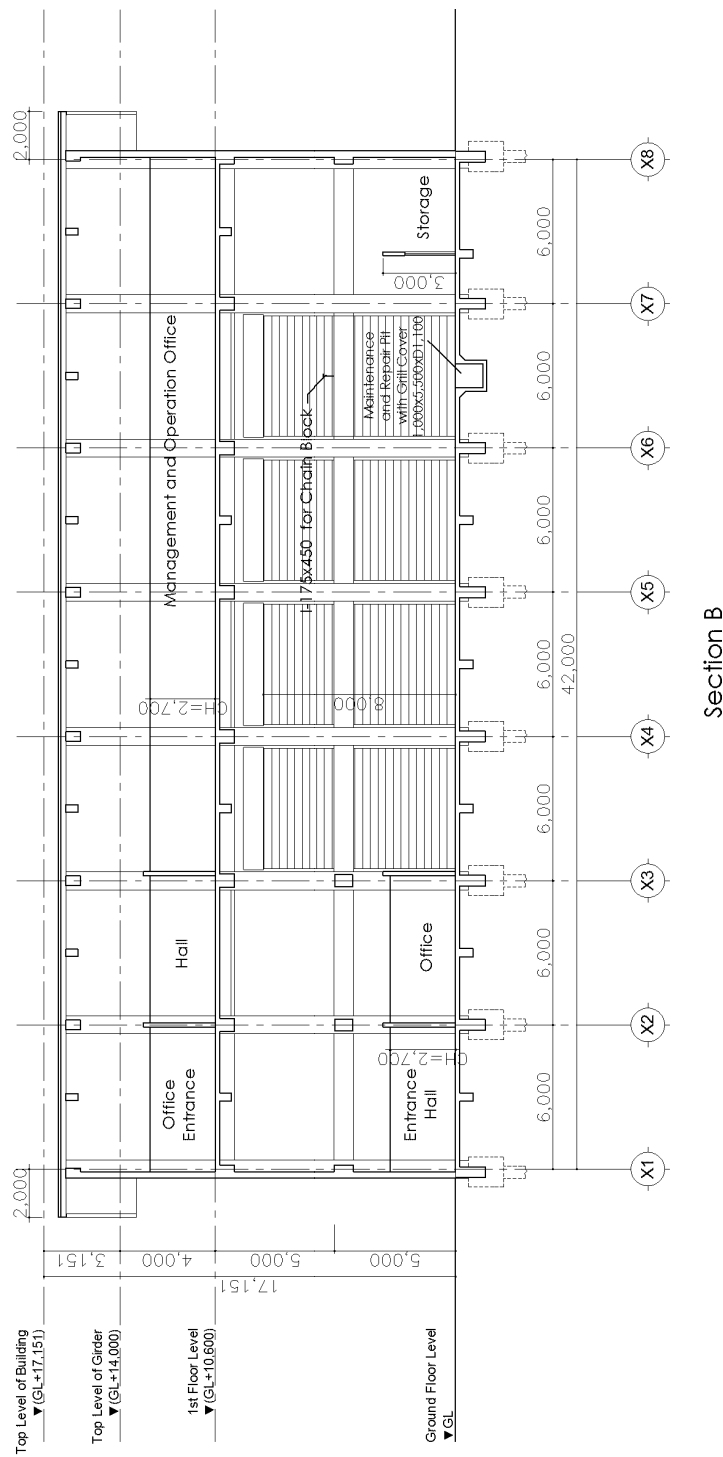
港湾事務所／ワークショッップ 断面図 (2/2)
